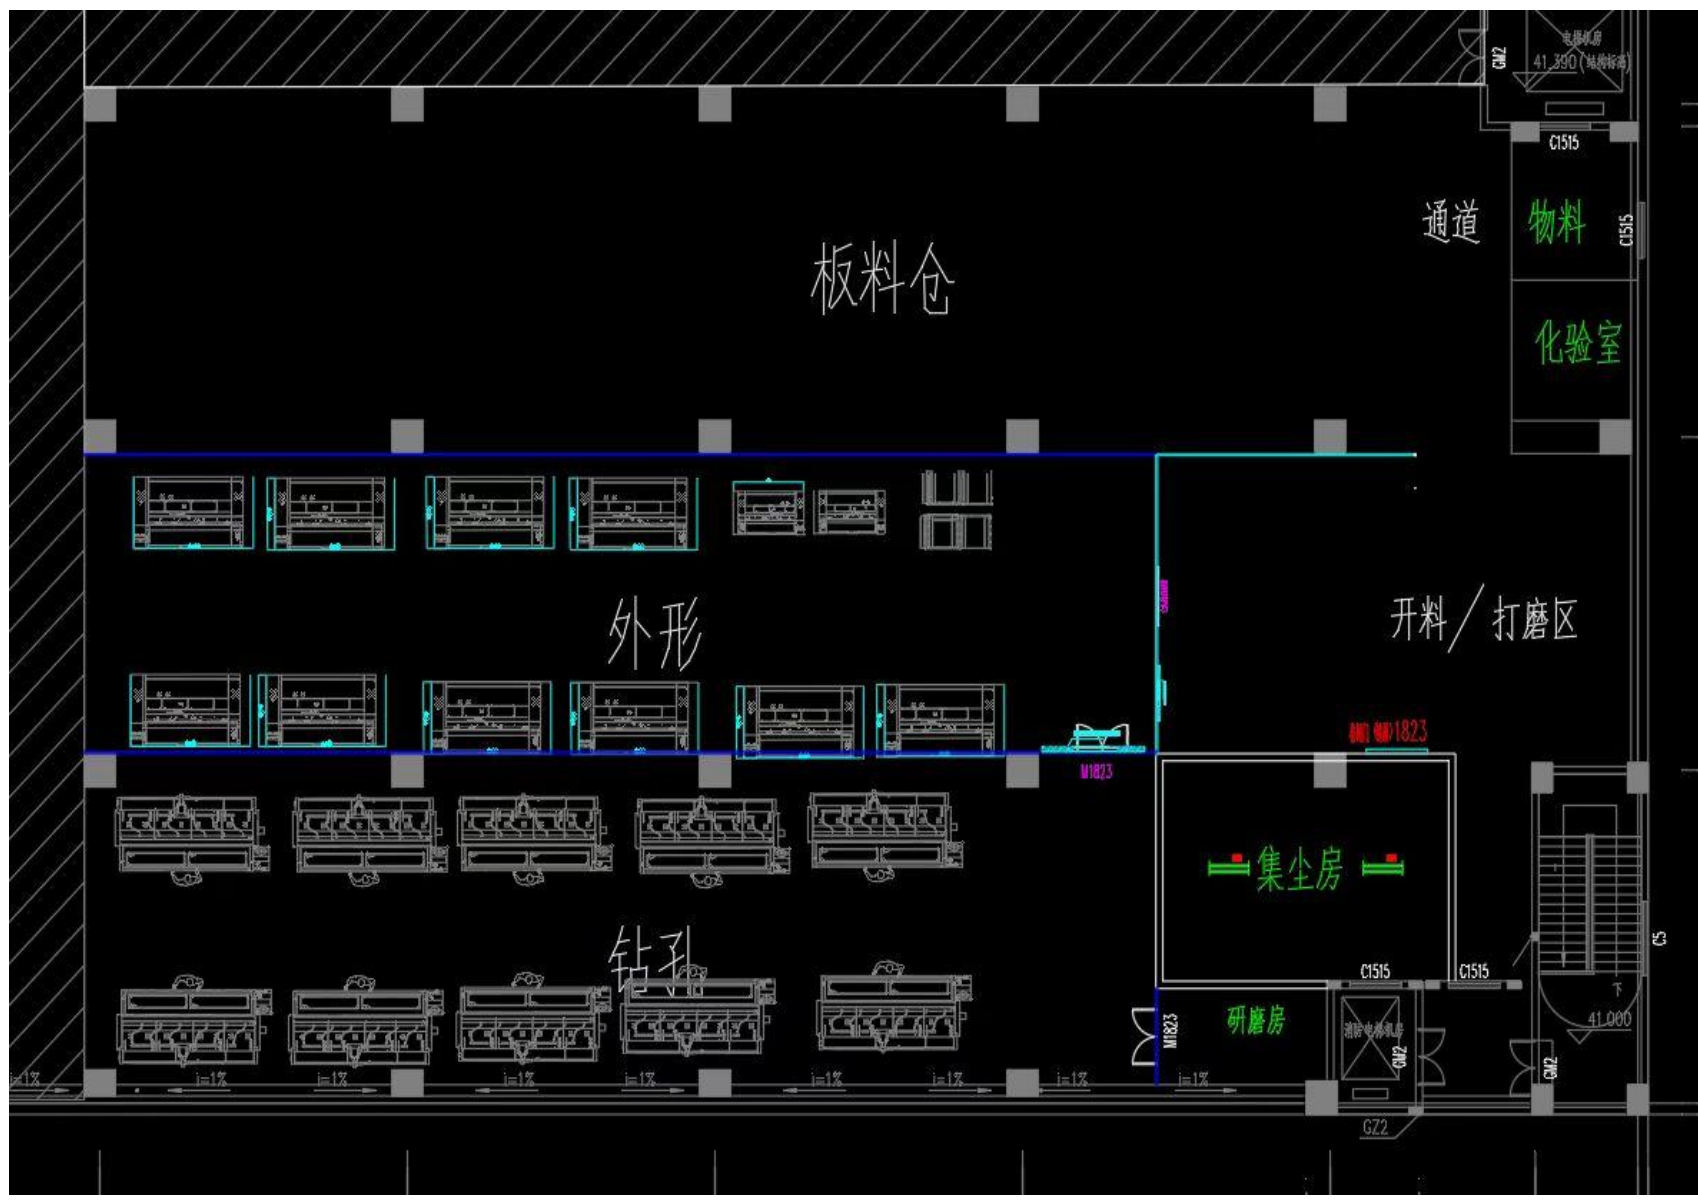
本项目三号厂房 1 楼右区实际平面布置图
